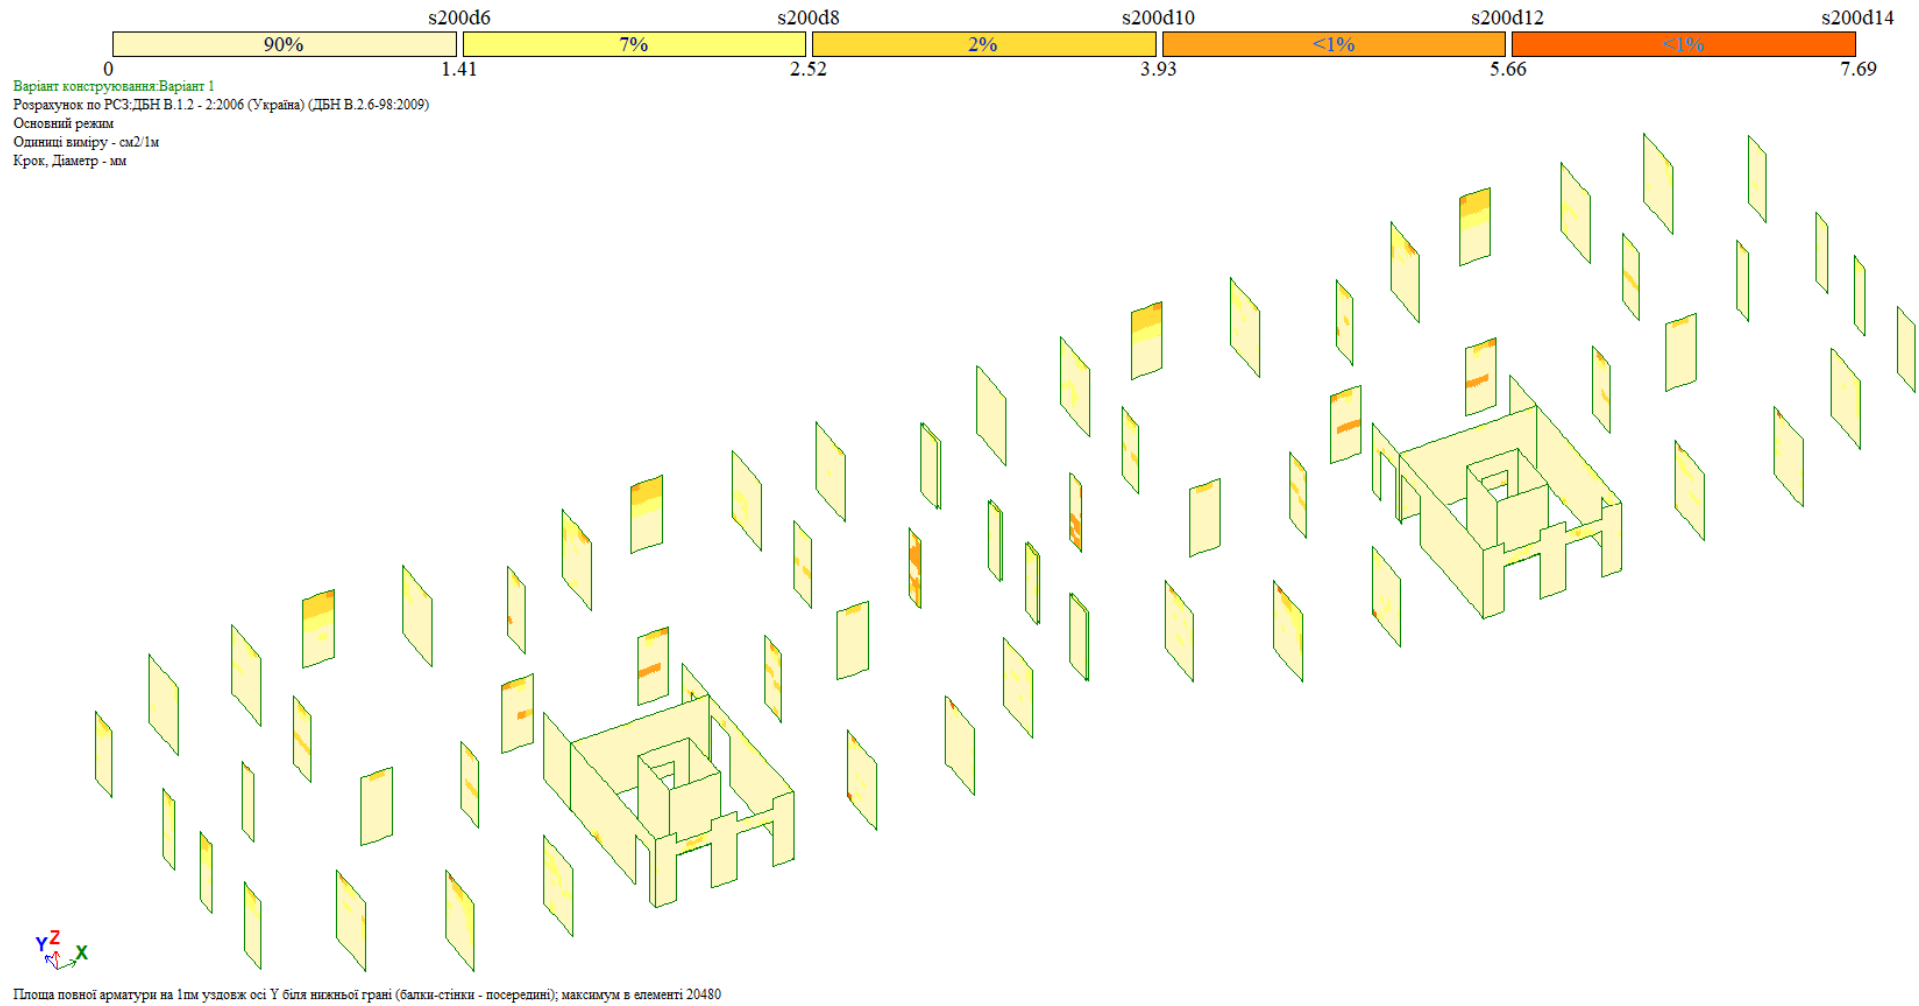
Вертикальне армування (см²/1м) стін та пілонів 1-го поверху
